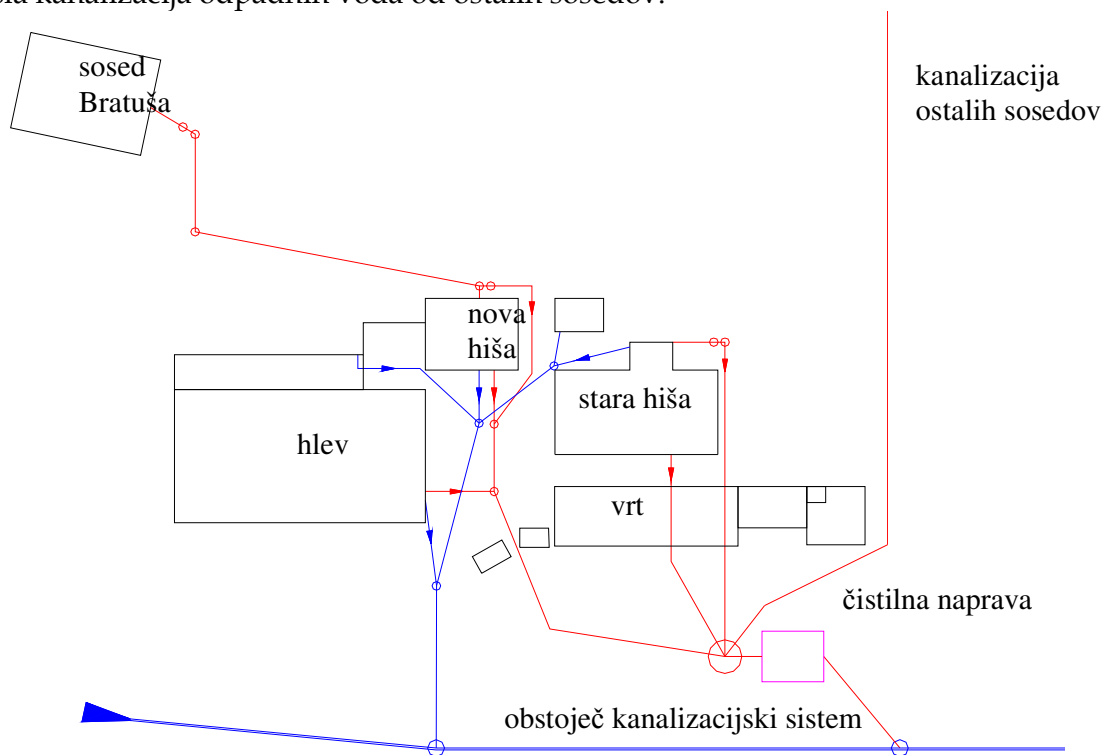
Plan izgradnje kanalizacijskega sistema in čistilne naprave jug 16 PE
